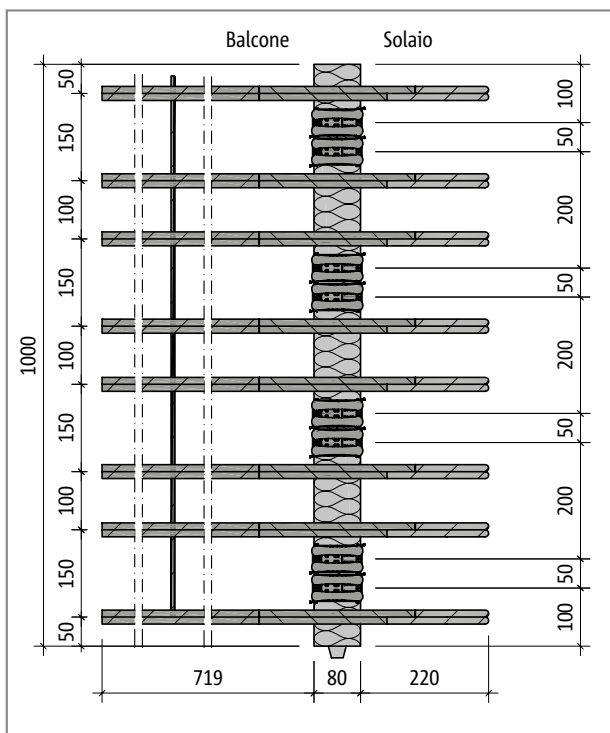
Schöck Isokorb® tipo Q60M-VV, pianta del prodotto
